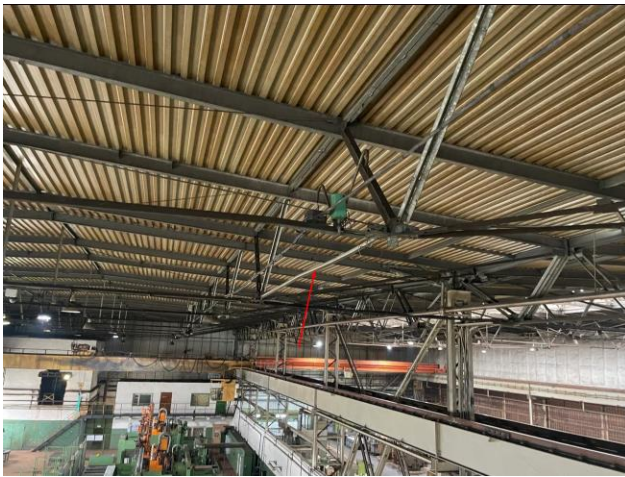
Выгиб элемента конструкции покрытия по нижнему поясу.
